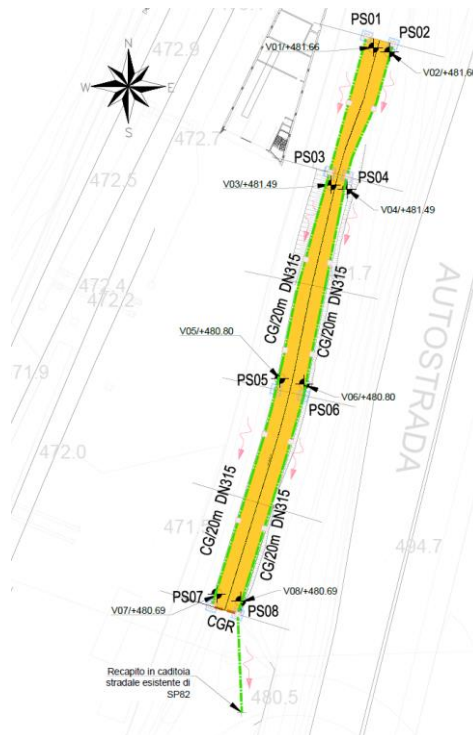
Planimetria idraulica di progetto NV090 I Tratto
